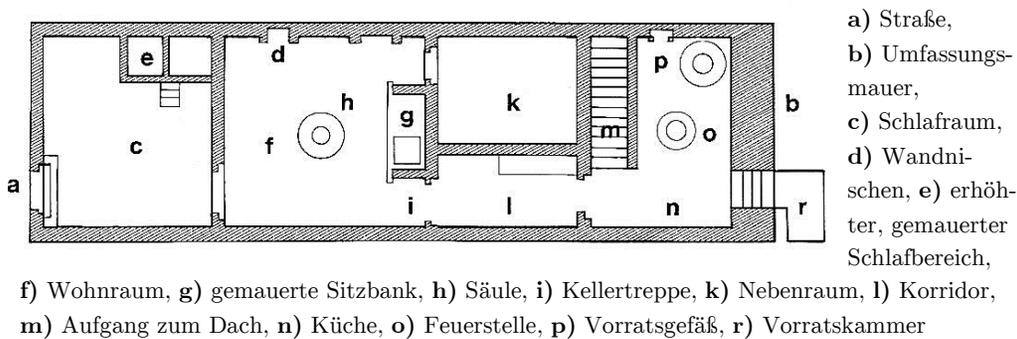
Grundriss eines Wohnhauses in Deir el-Medina
